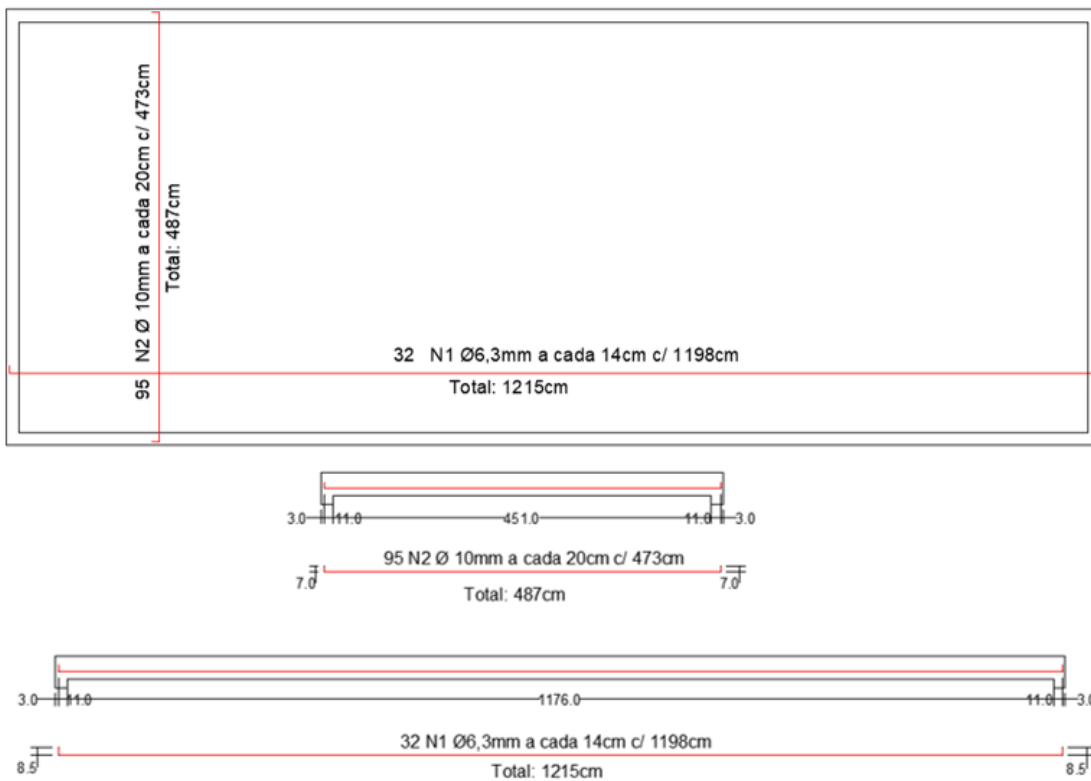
Detalhamento de armadura positiva da laje L1 - TQS
